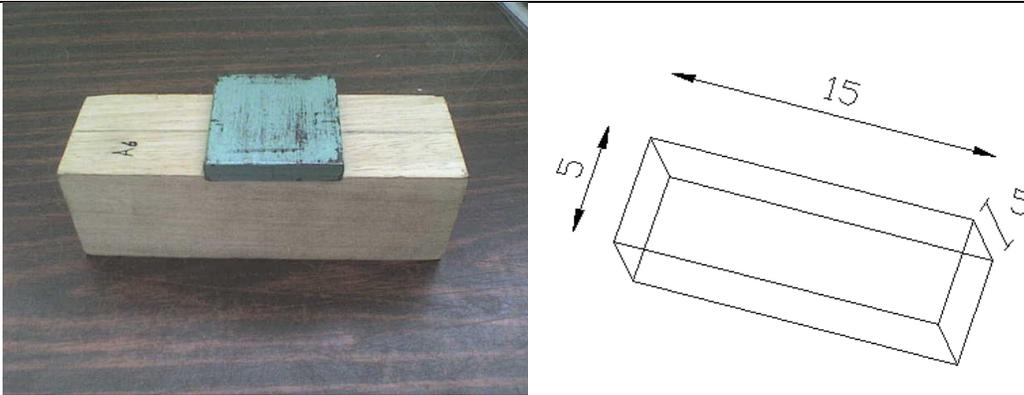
Probeta para ensayo de compresión perpendicular con placa
